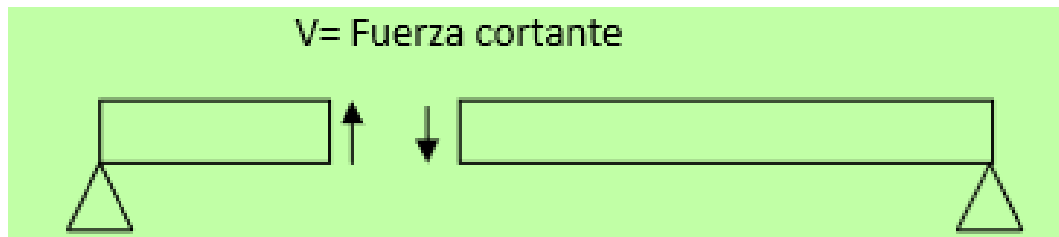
Comportamiento de la Fuerza Cortante en una Viga. Fuente Rafael Contreras.
